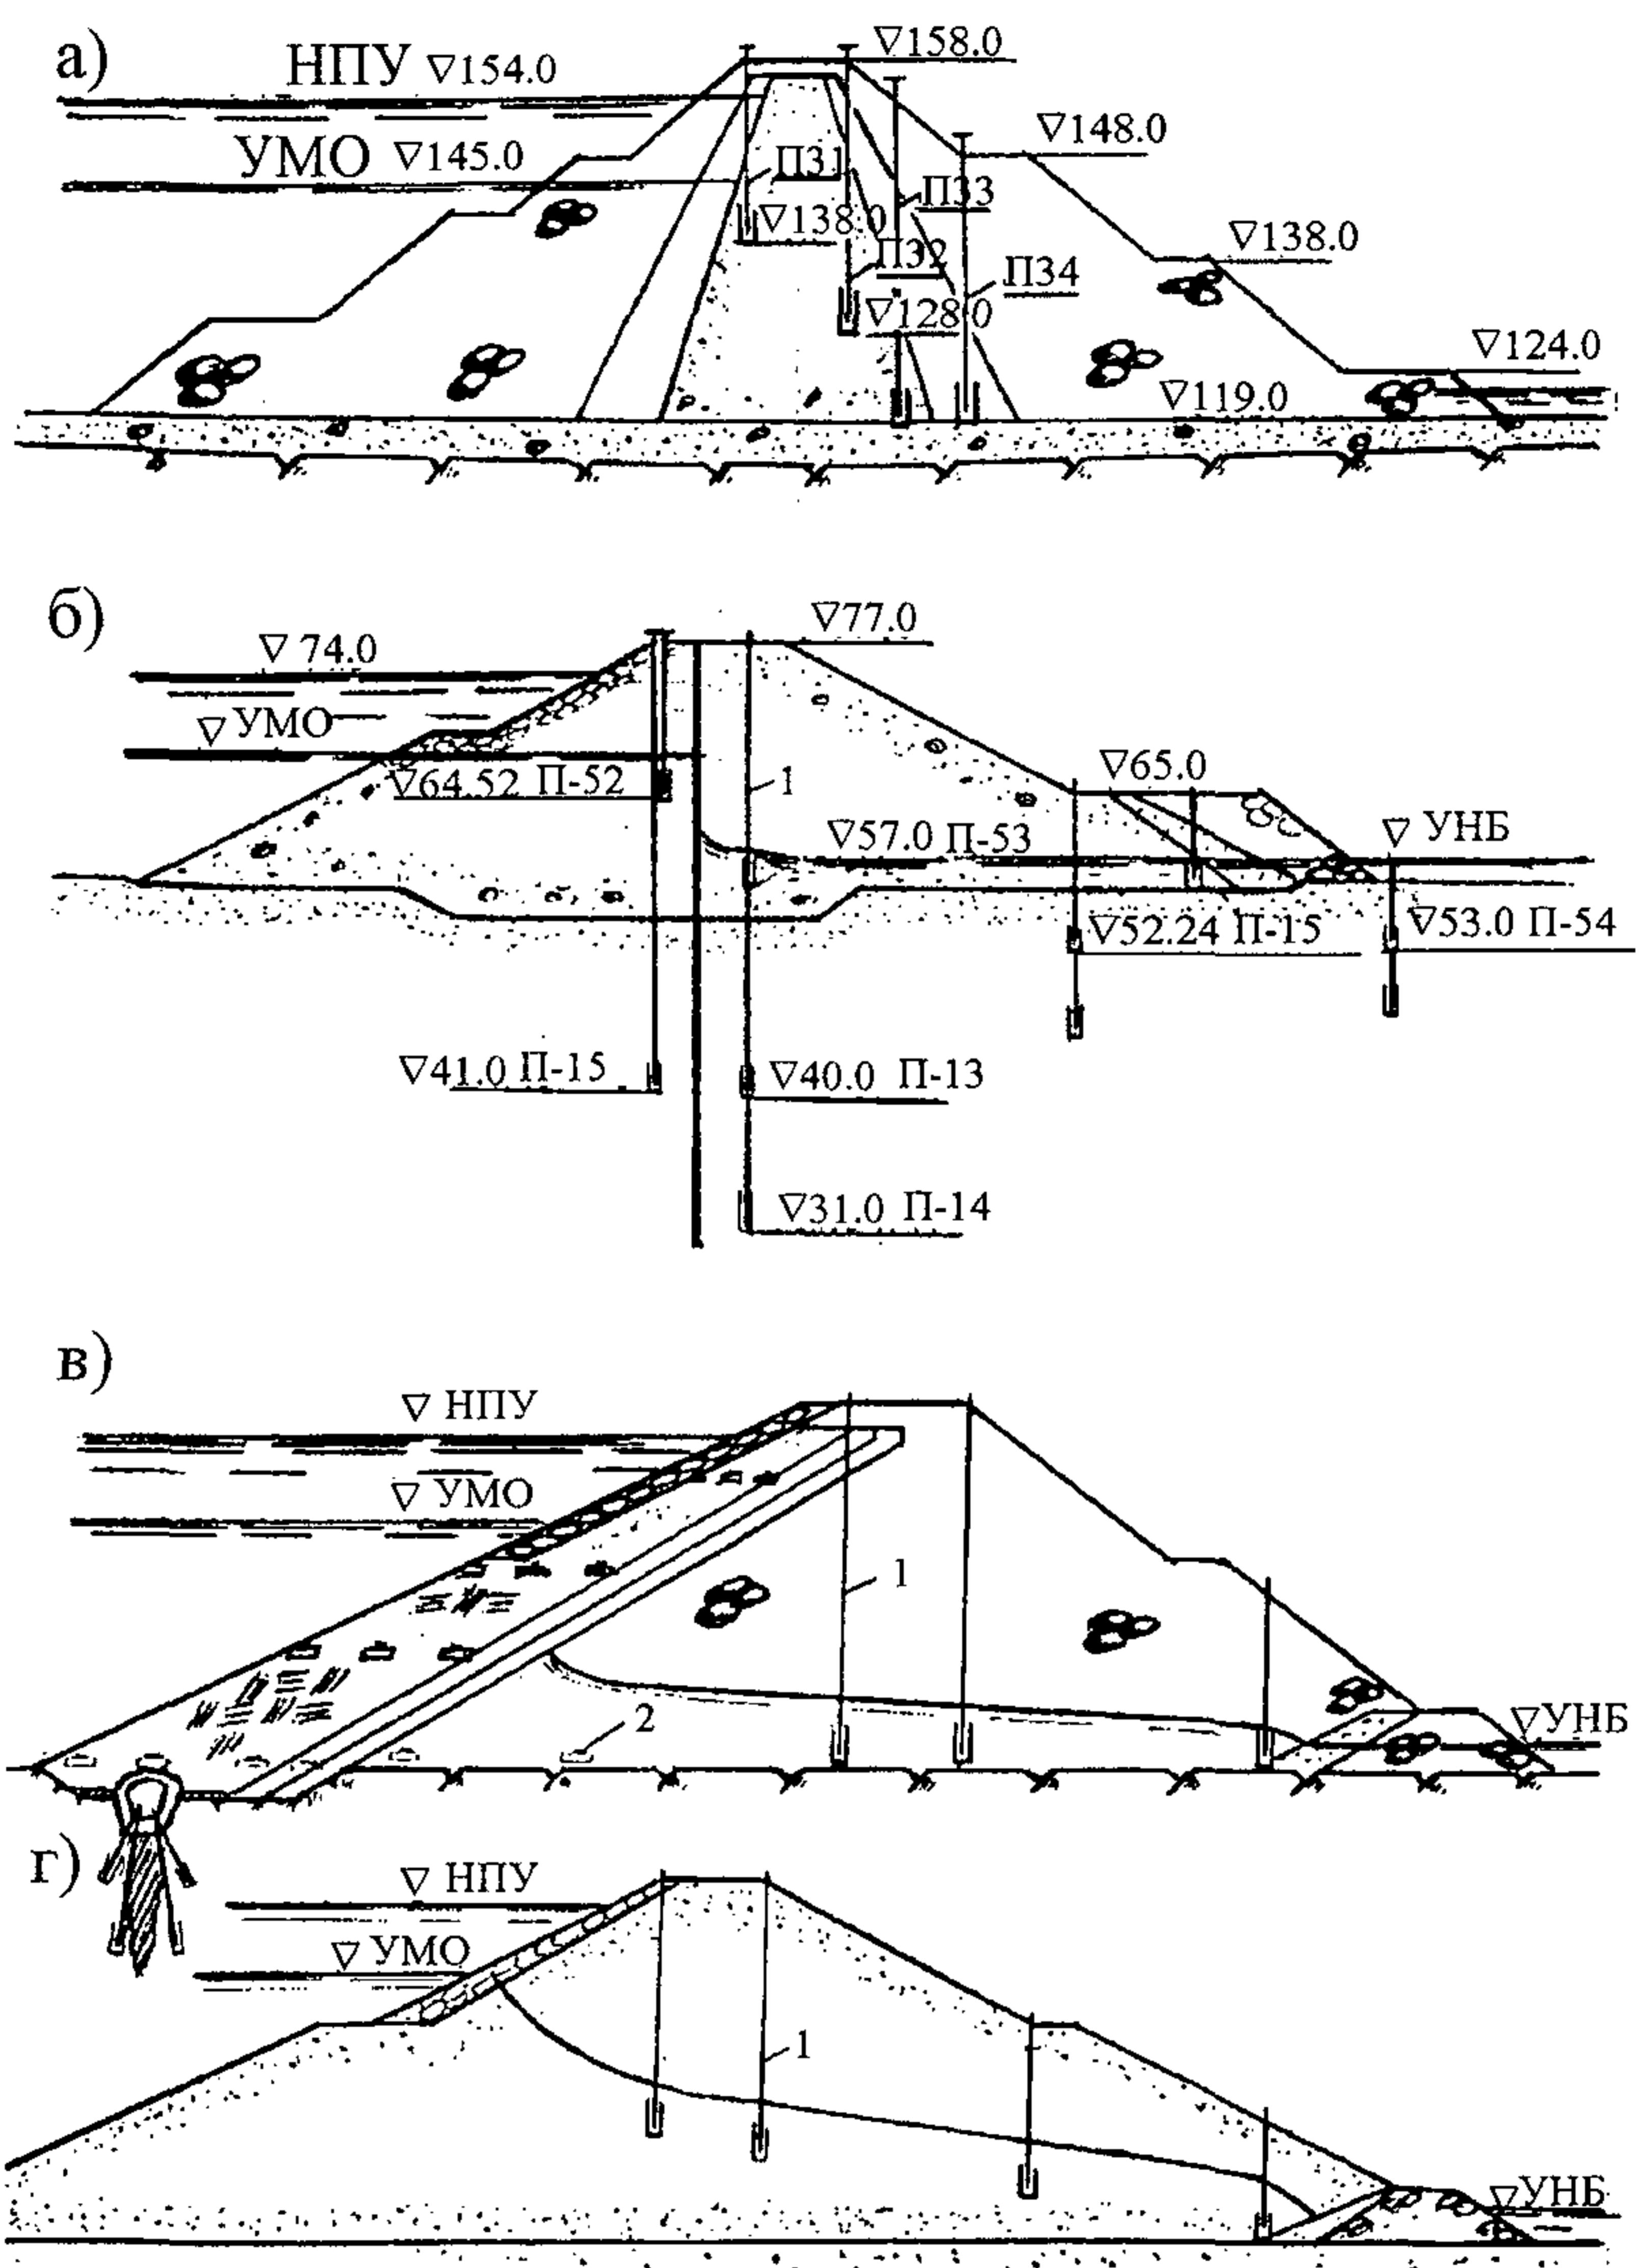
Принципиальные схемы размещения пьезометров в грунтовых плотинах:
